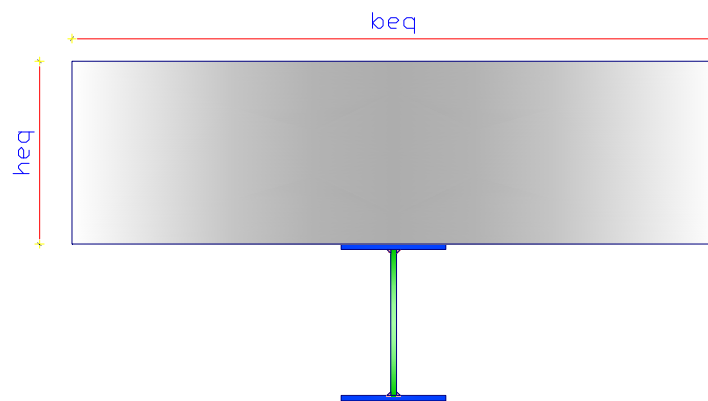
Sección de hormigón equivalente sobre perfil metálico
